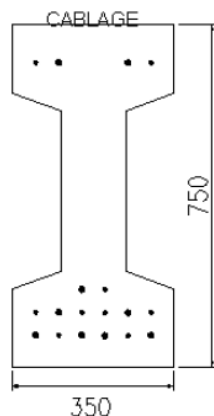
Coupe transversale d'une poutre précontrainte en BFUP utilisée pour la réalisation du pont de Saint Pierre la Cour [Bouteille, 2005]
